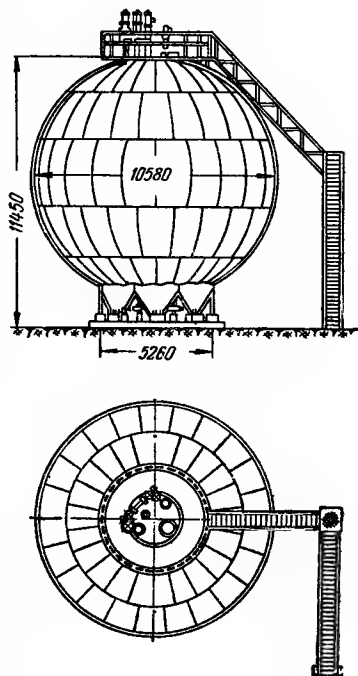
Шаровой резервуар емкостью 600 м^3 , опирающийся на цилиндрический стакан
